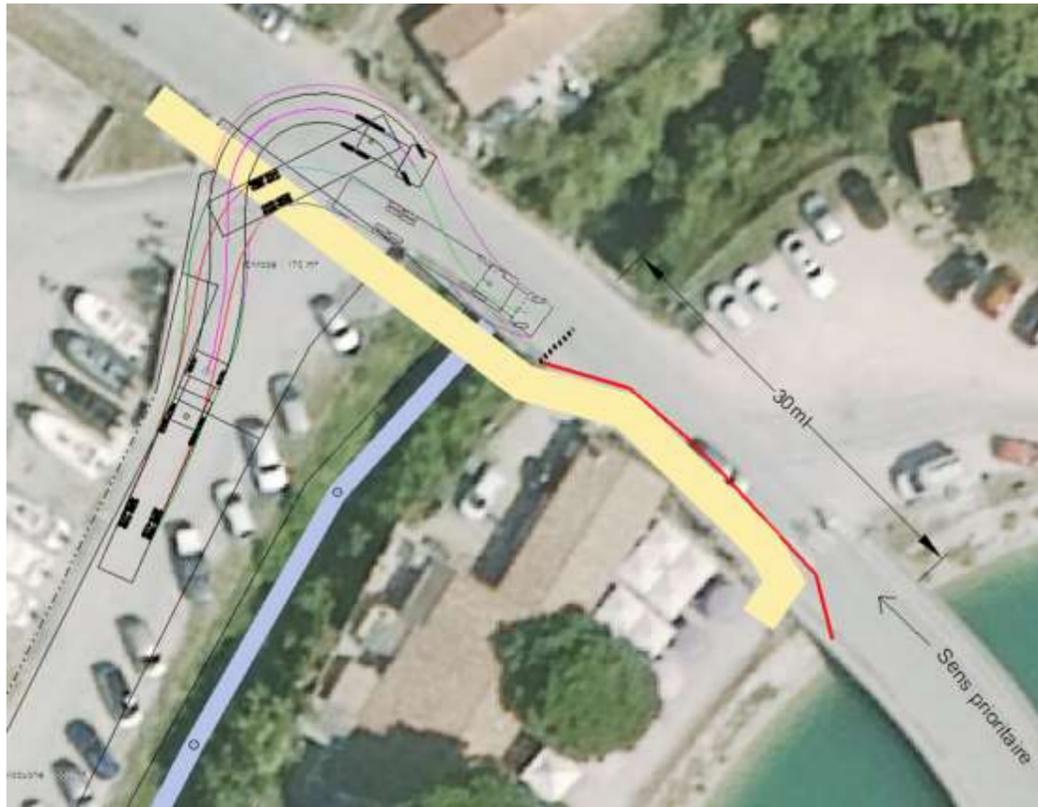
Vue en plan de la proposition 3 (Source : Unima)
